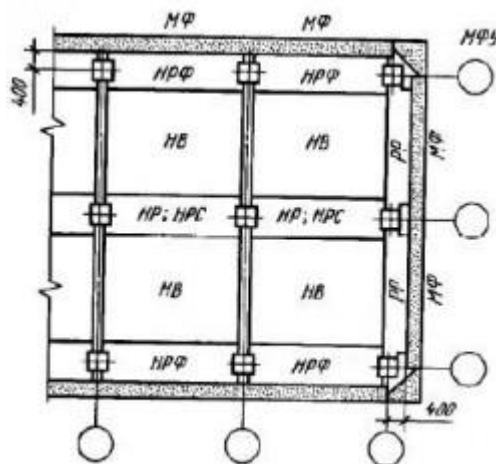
Фрагмент плана перекрытий каркасного здания:
